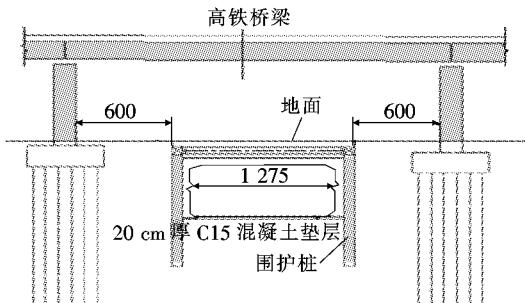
箱涵(框架桥)施工防护示意图(单位:mm)
